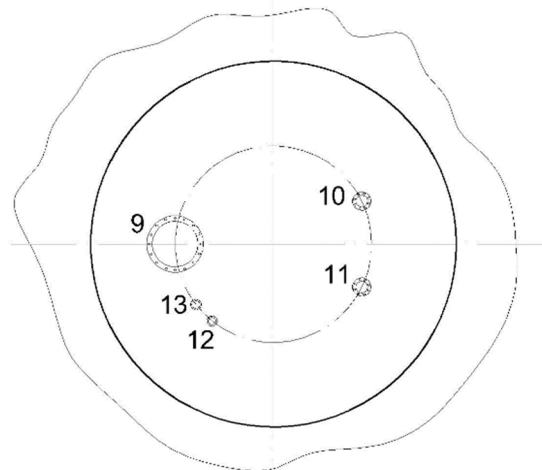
Низ резервуара $V = 600 \text{ м}^3$
